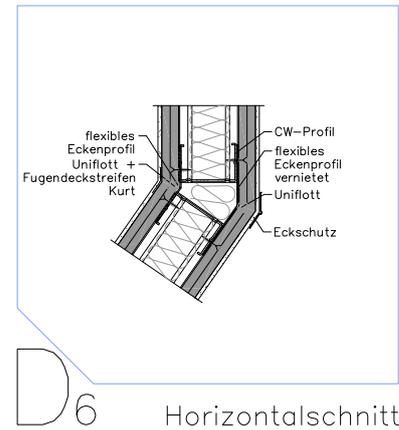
Detail 6 - Eckdetail, M= 1:10
